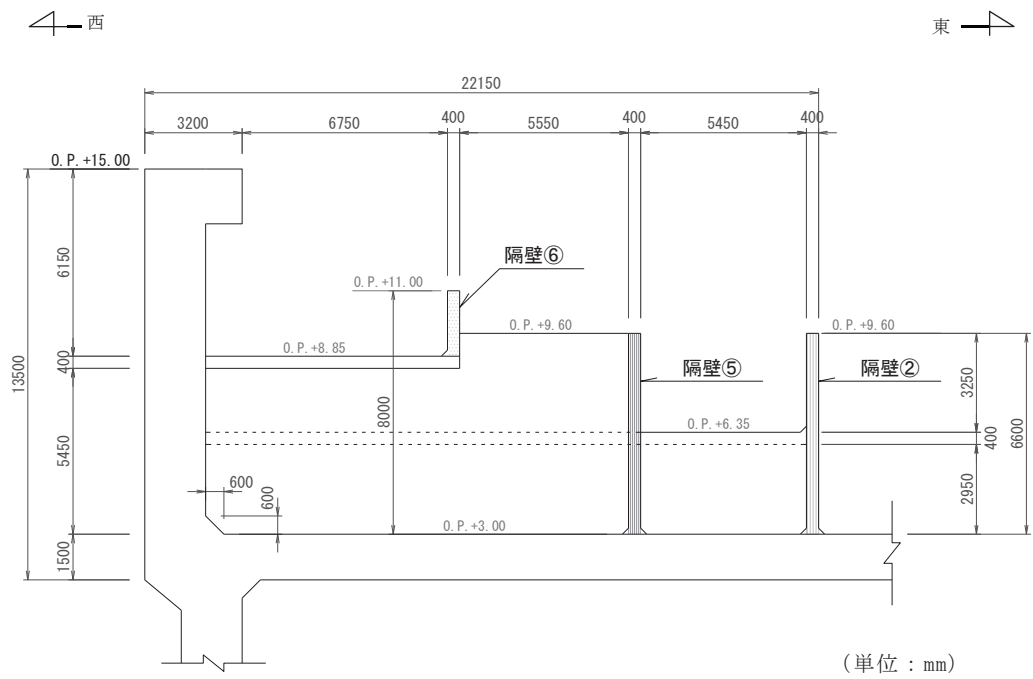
(6) 補機ポンプエリア断面図 (⑥—⑥断面)
